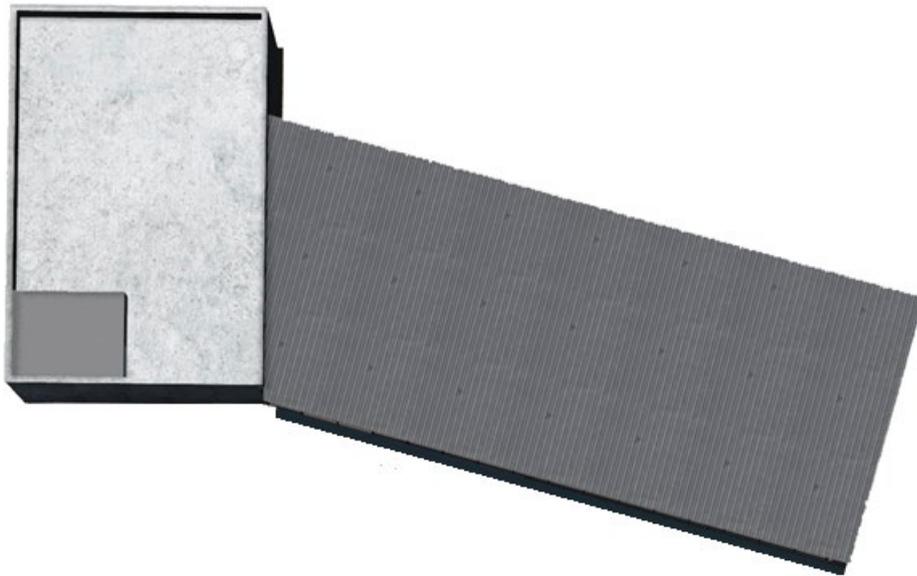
Cubierta del edificio. Fuente: Elaboración propia.
